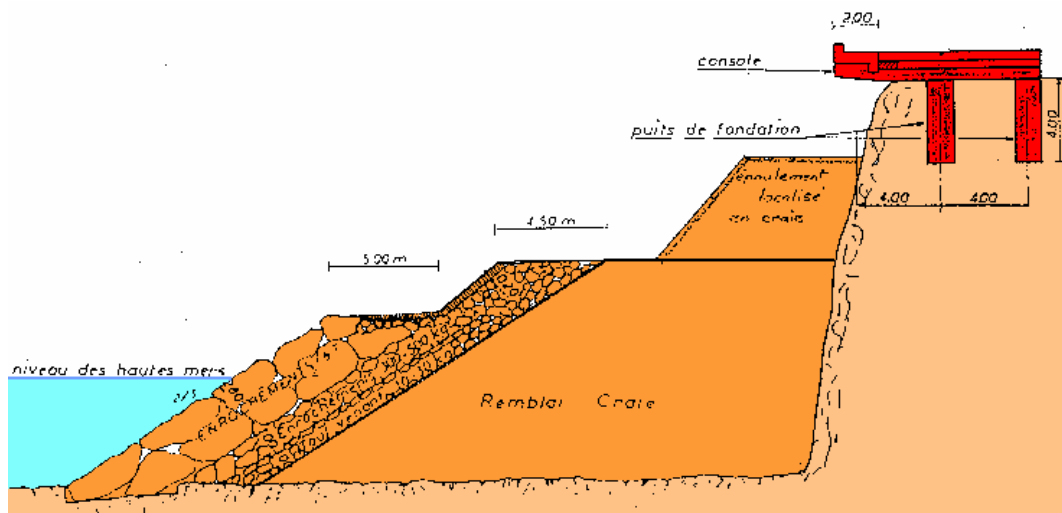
Ouvrage en enrochements en pied de falaise sur l'estran et ouvrage (en rouge) en béton sur le sommet de la falaise où reposent les habitations (cf.)
